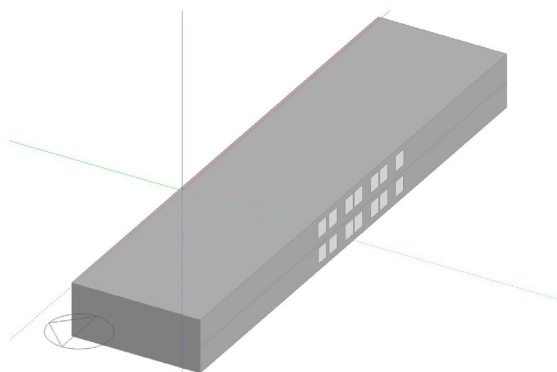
Figura del modelo de las plantas 3ª y 4ª creado en Desing Builder.
